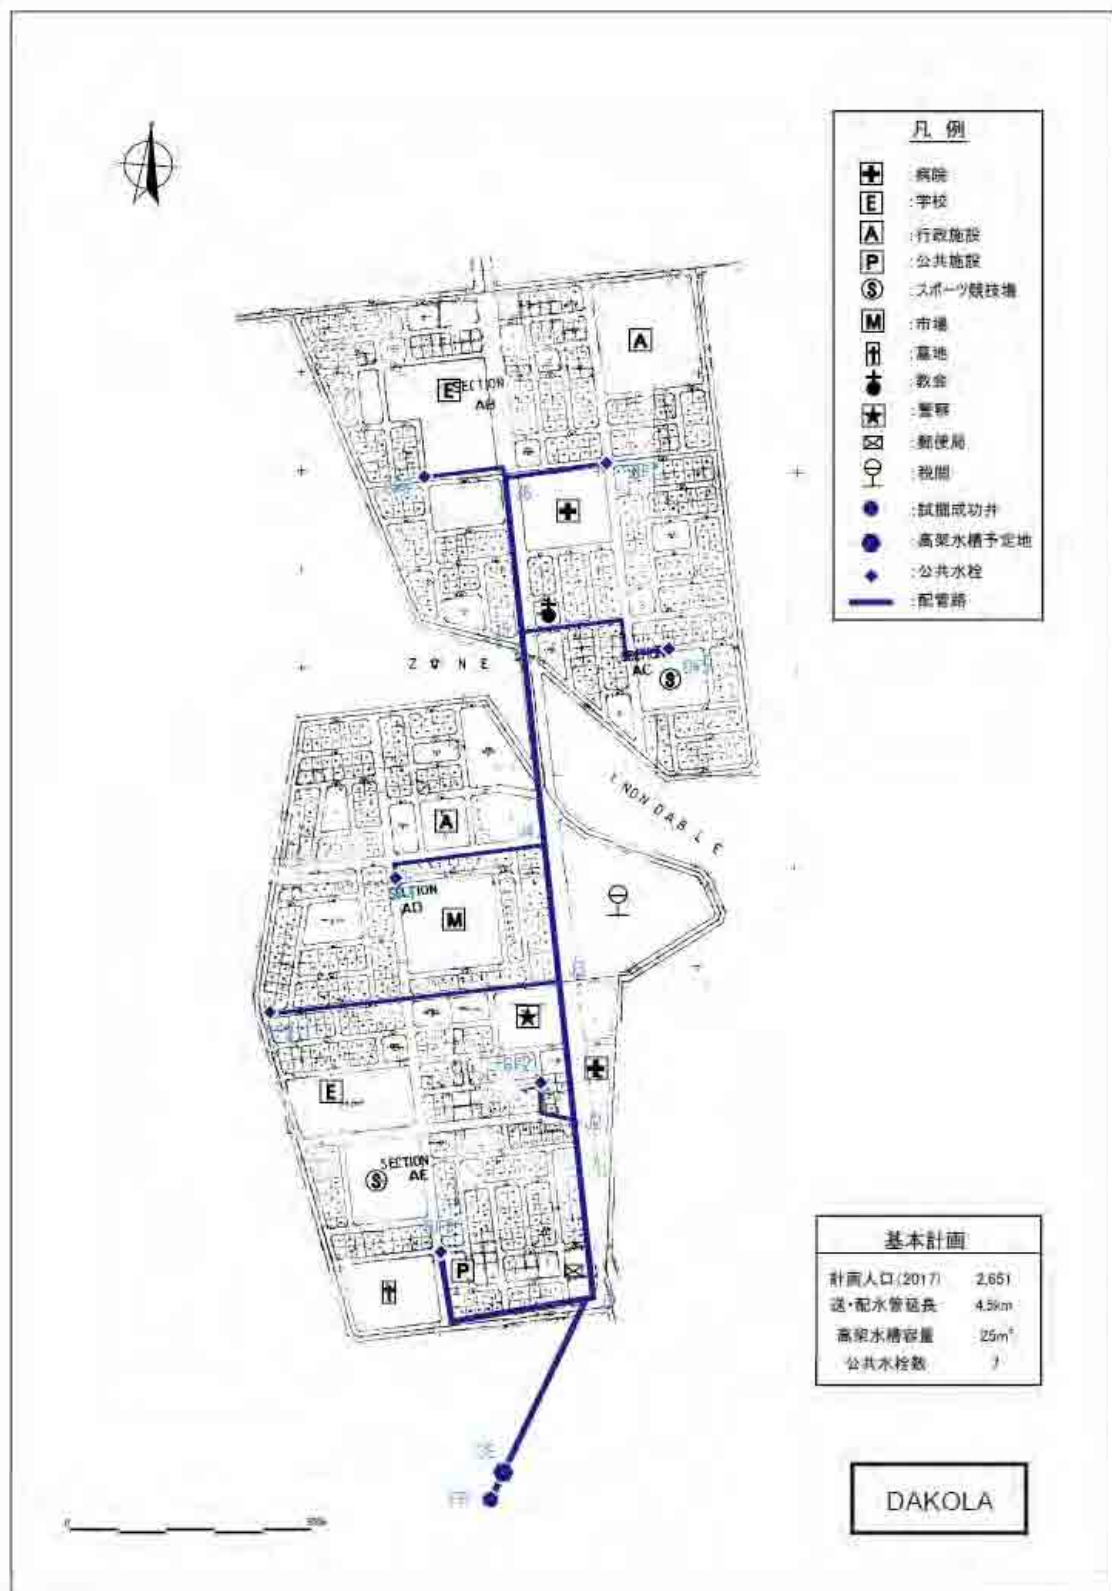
計画対象サイト(Dakola)の給水施設平面図
